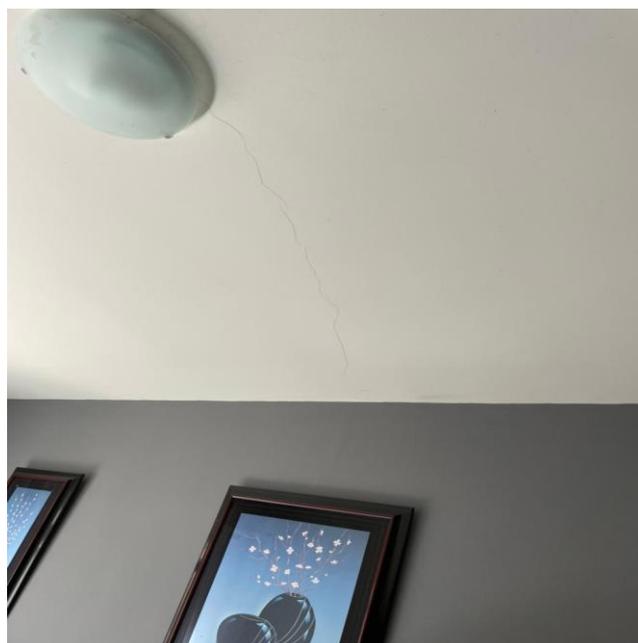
Apartamento 102 e do bloco A - Fissuras no teto.
